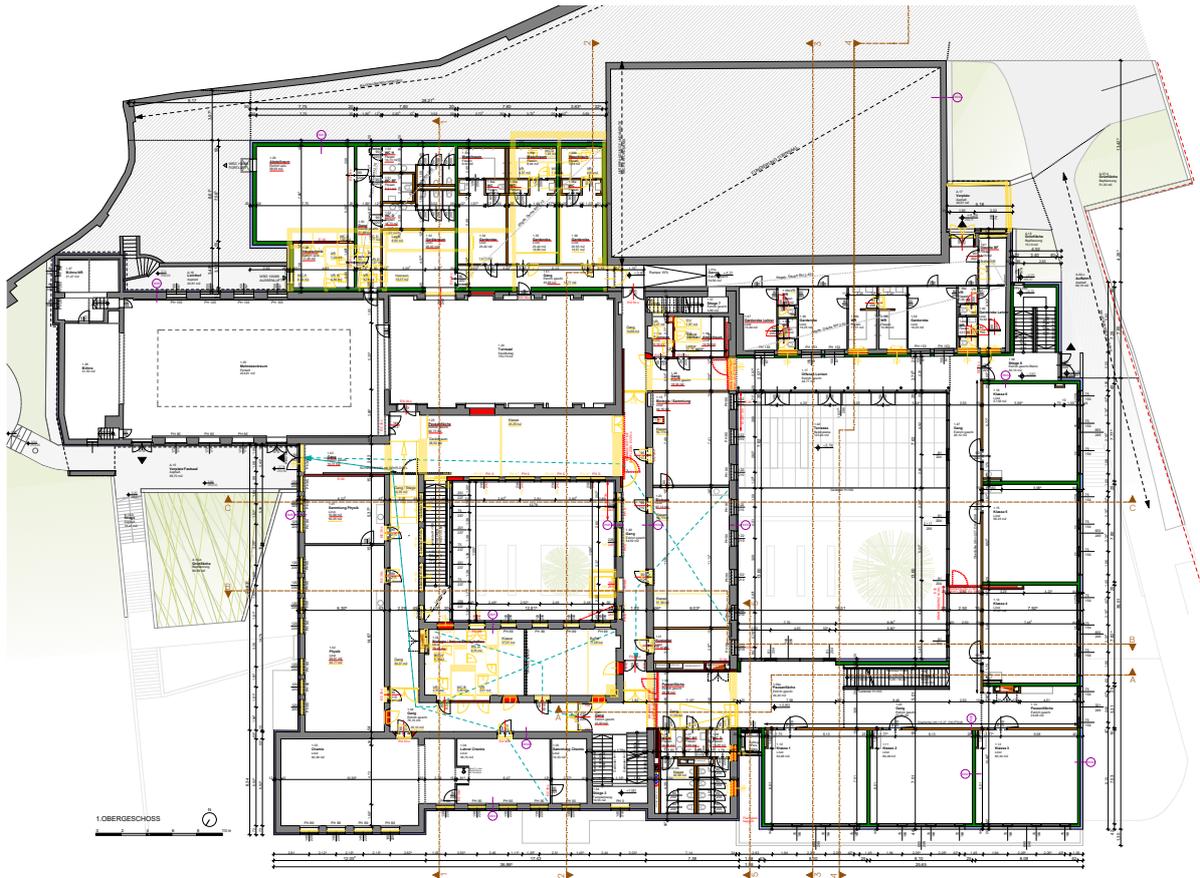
Grundriss 1. Obergeschoss
